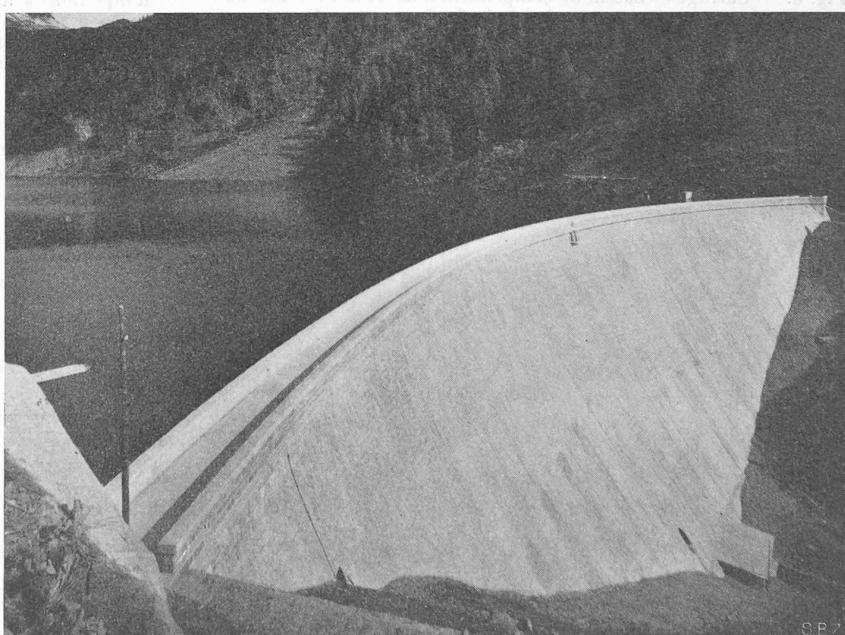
Barrage d'Agaro du groupe d'usines de la vallée d'Ossola. Vue d'aval.
